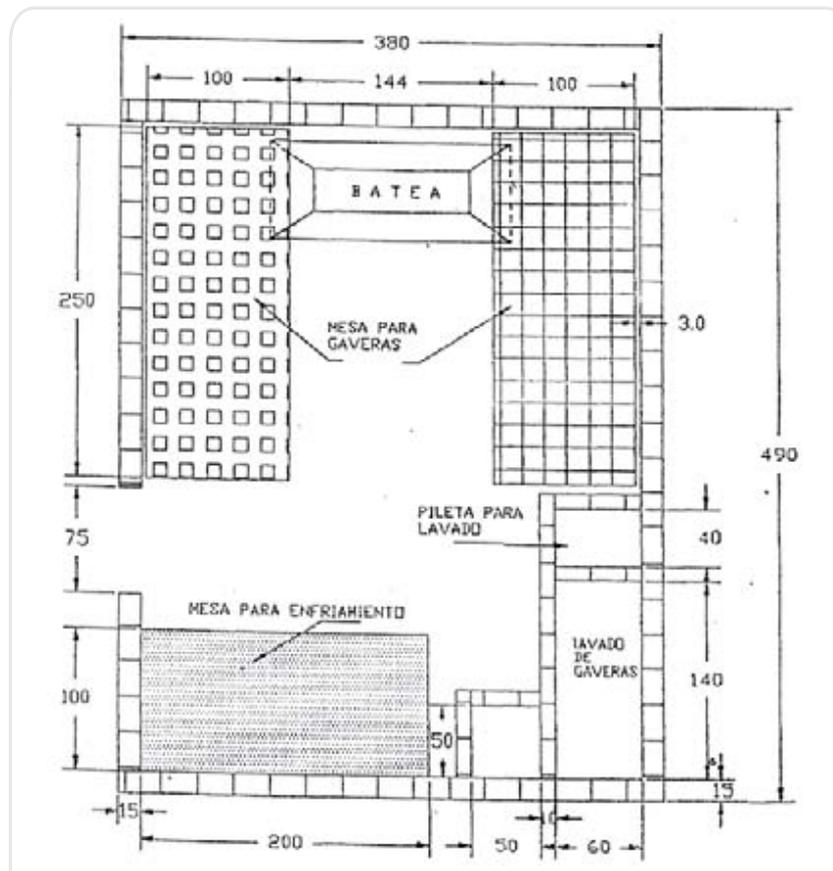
Vista en planta del cuarto de batido y moldeo para la elaboración de panela
